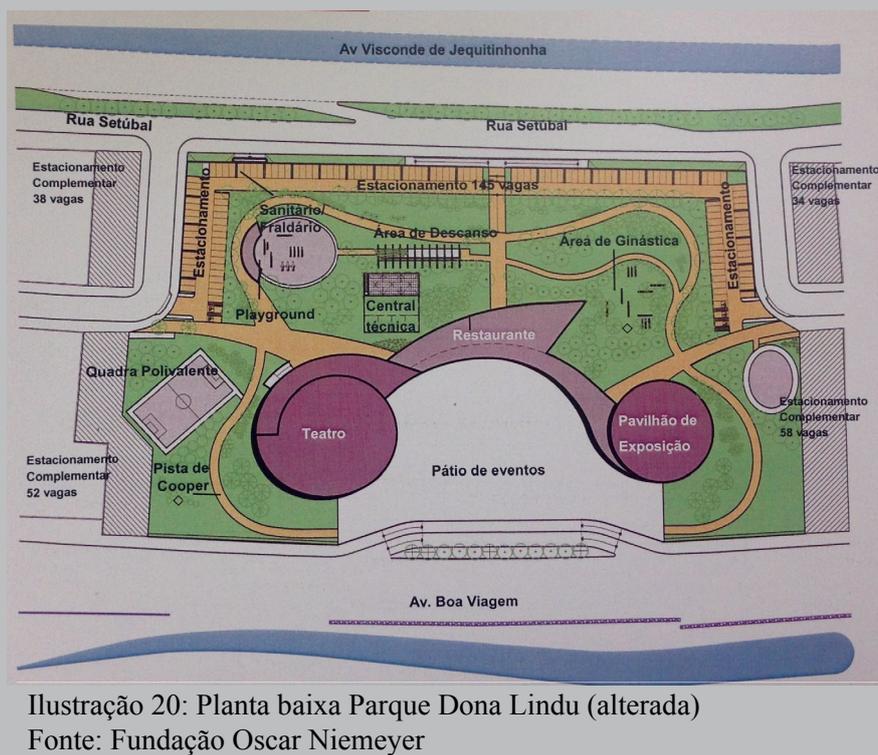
Planta baixa Parque Dona Lindu (alterada)
